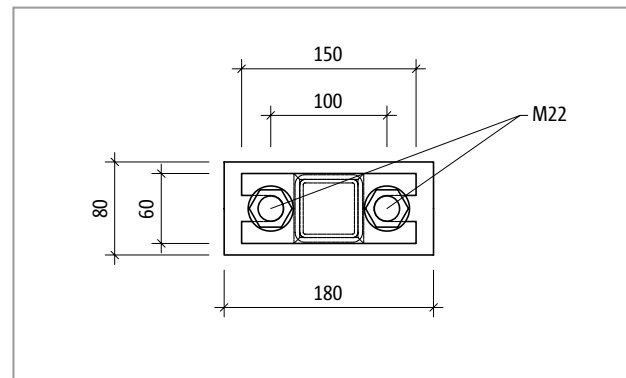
Schöck Isokorb® T type S-V-D22: Elevation of the product
